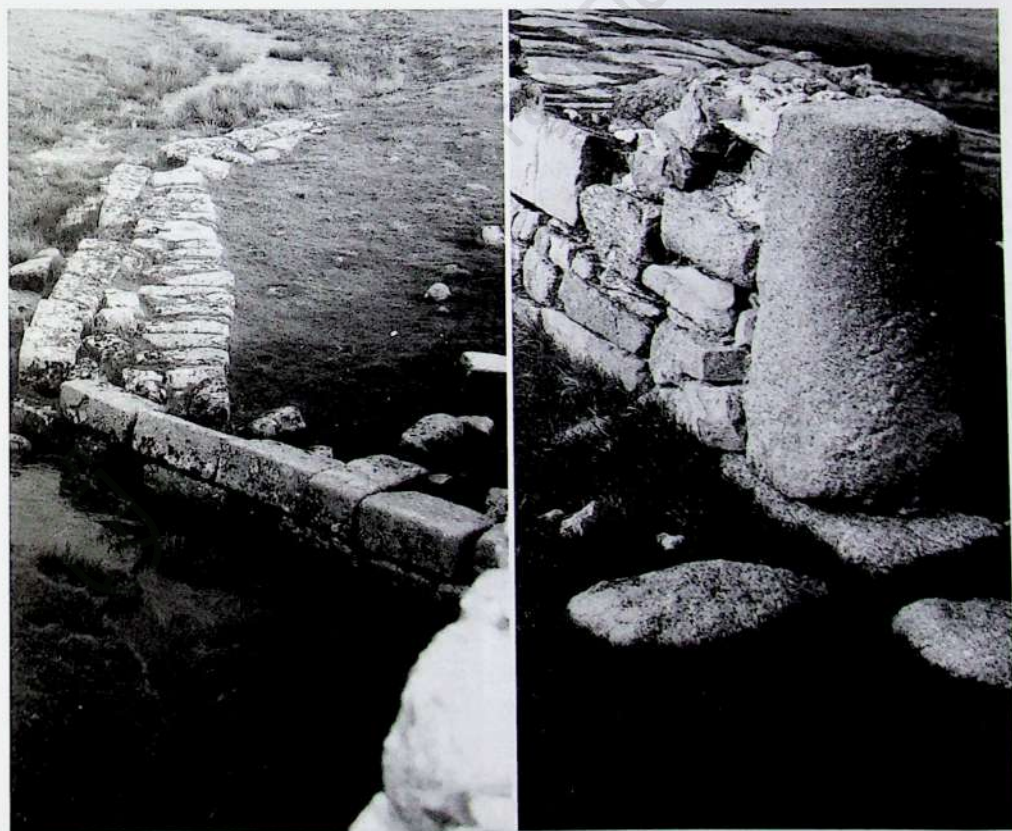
y 41. Campo Azálvaro. Puente de "Los Llanos". Salida sur y pilar de cierre. Malecón de entrada al arco extremo S.
